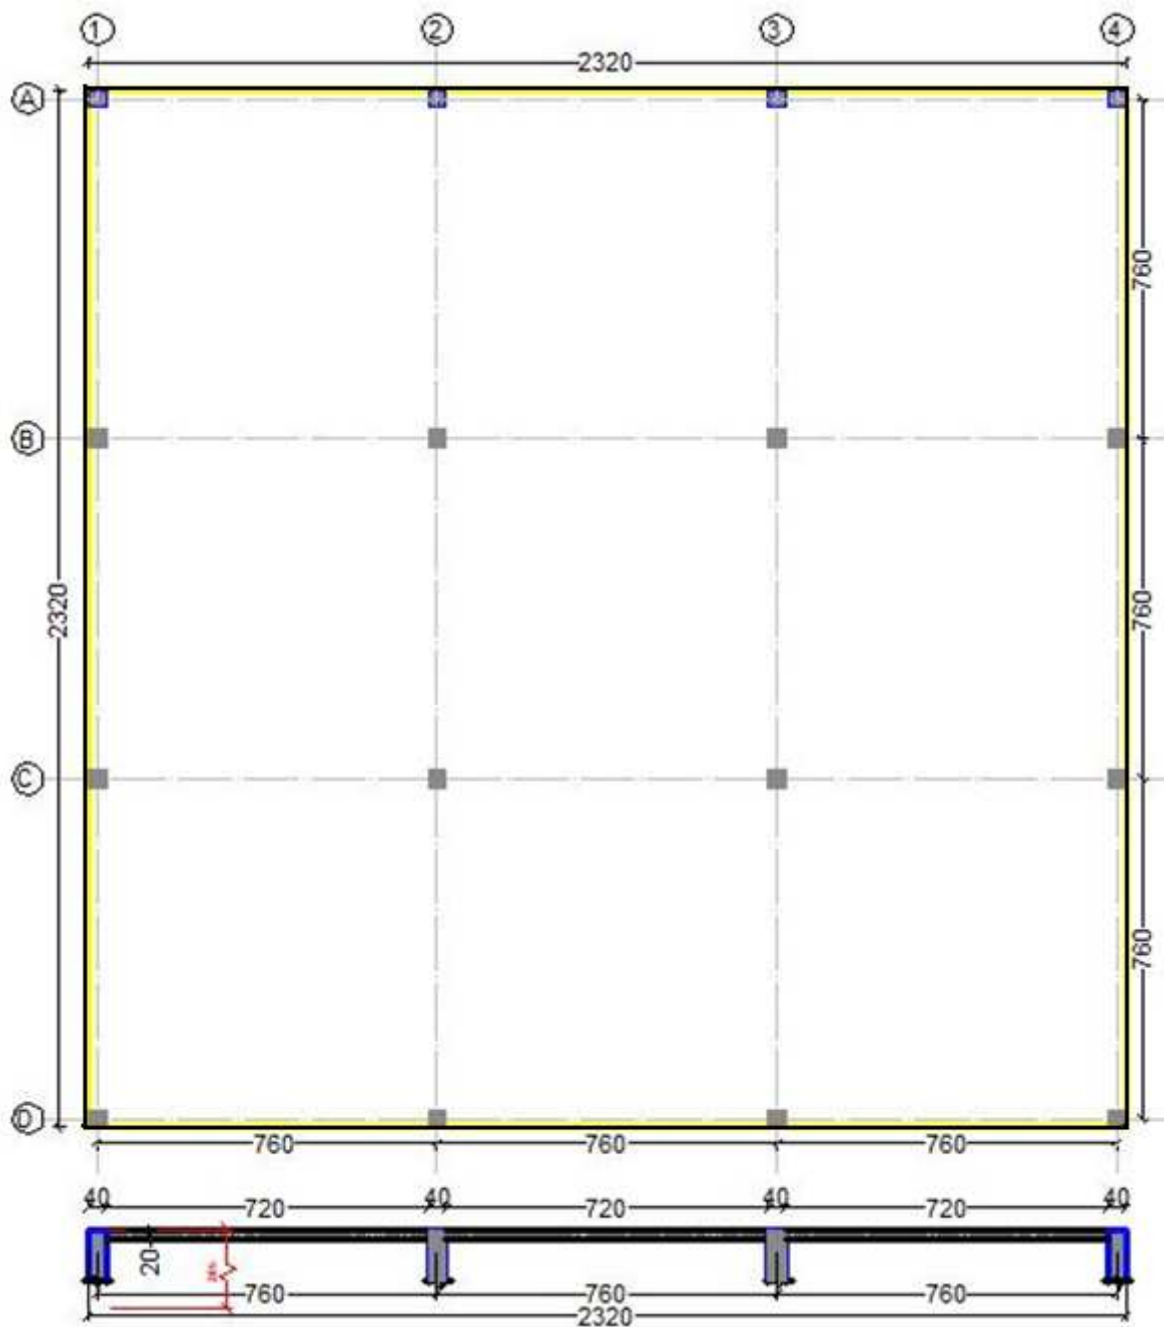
Planta baixa e elevação da FÔRMA_5
